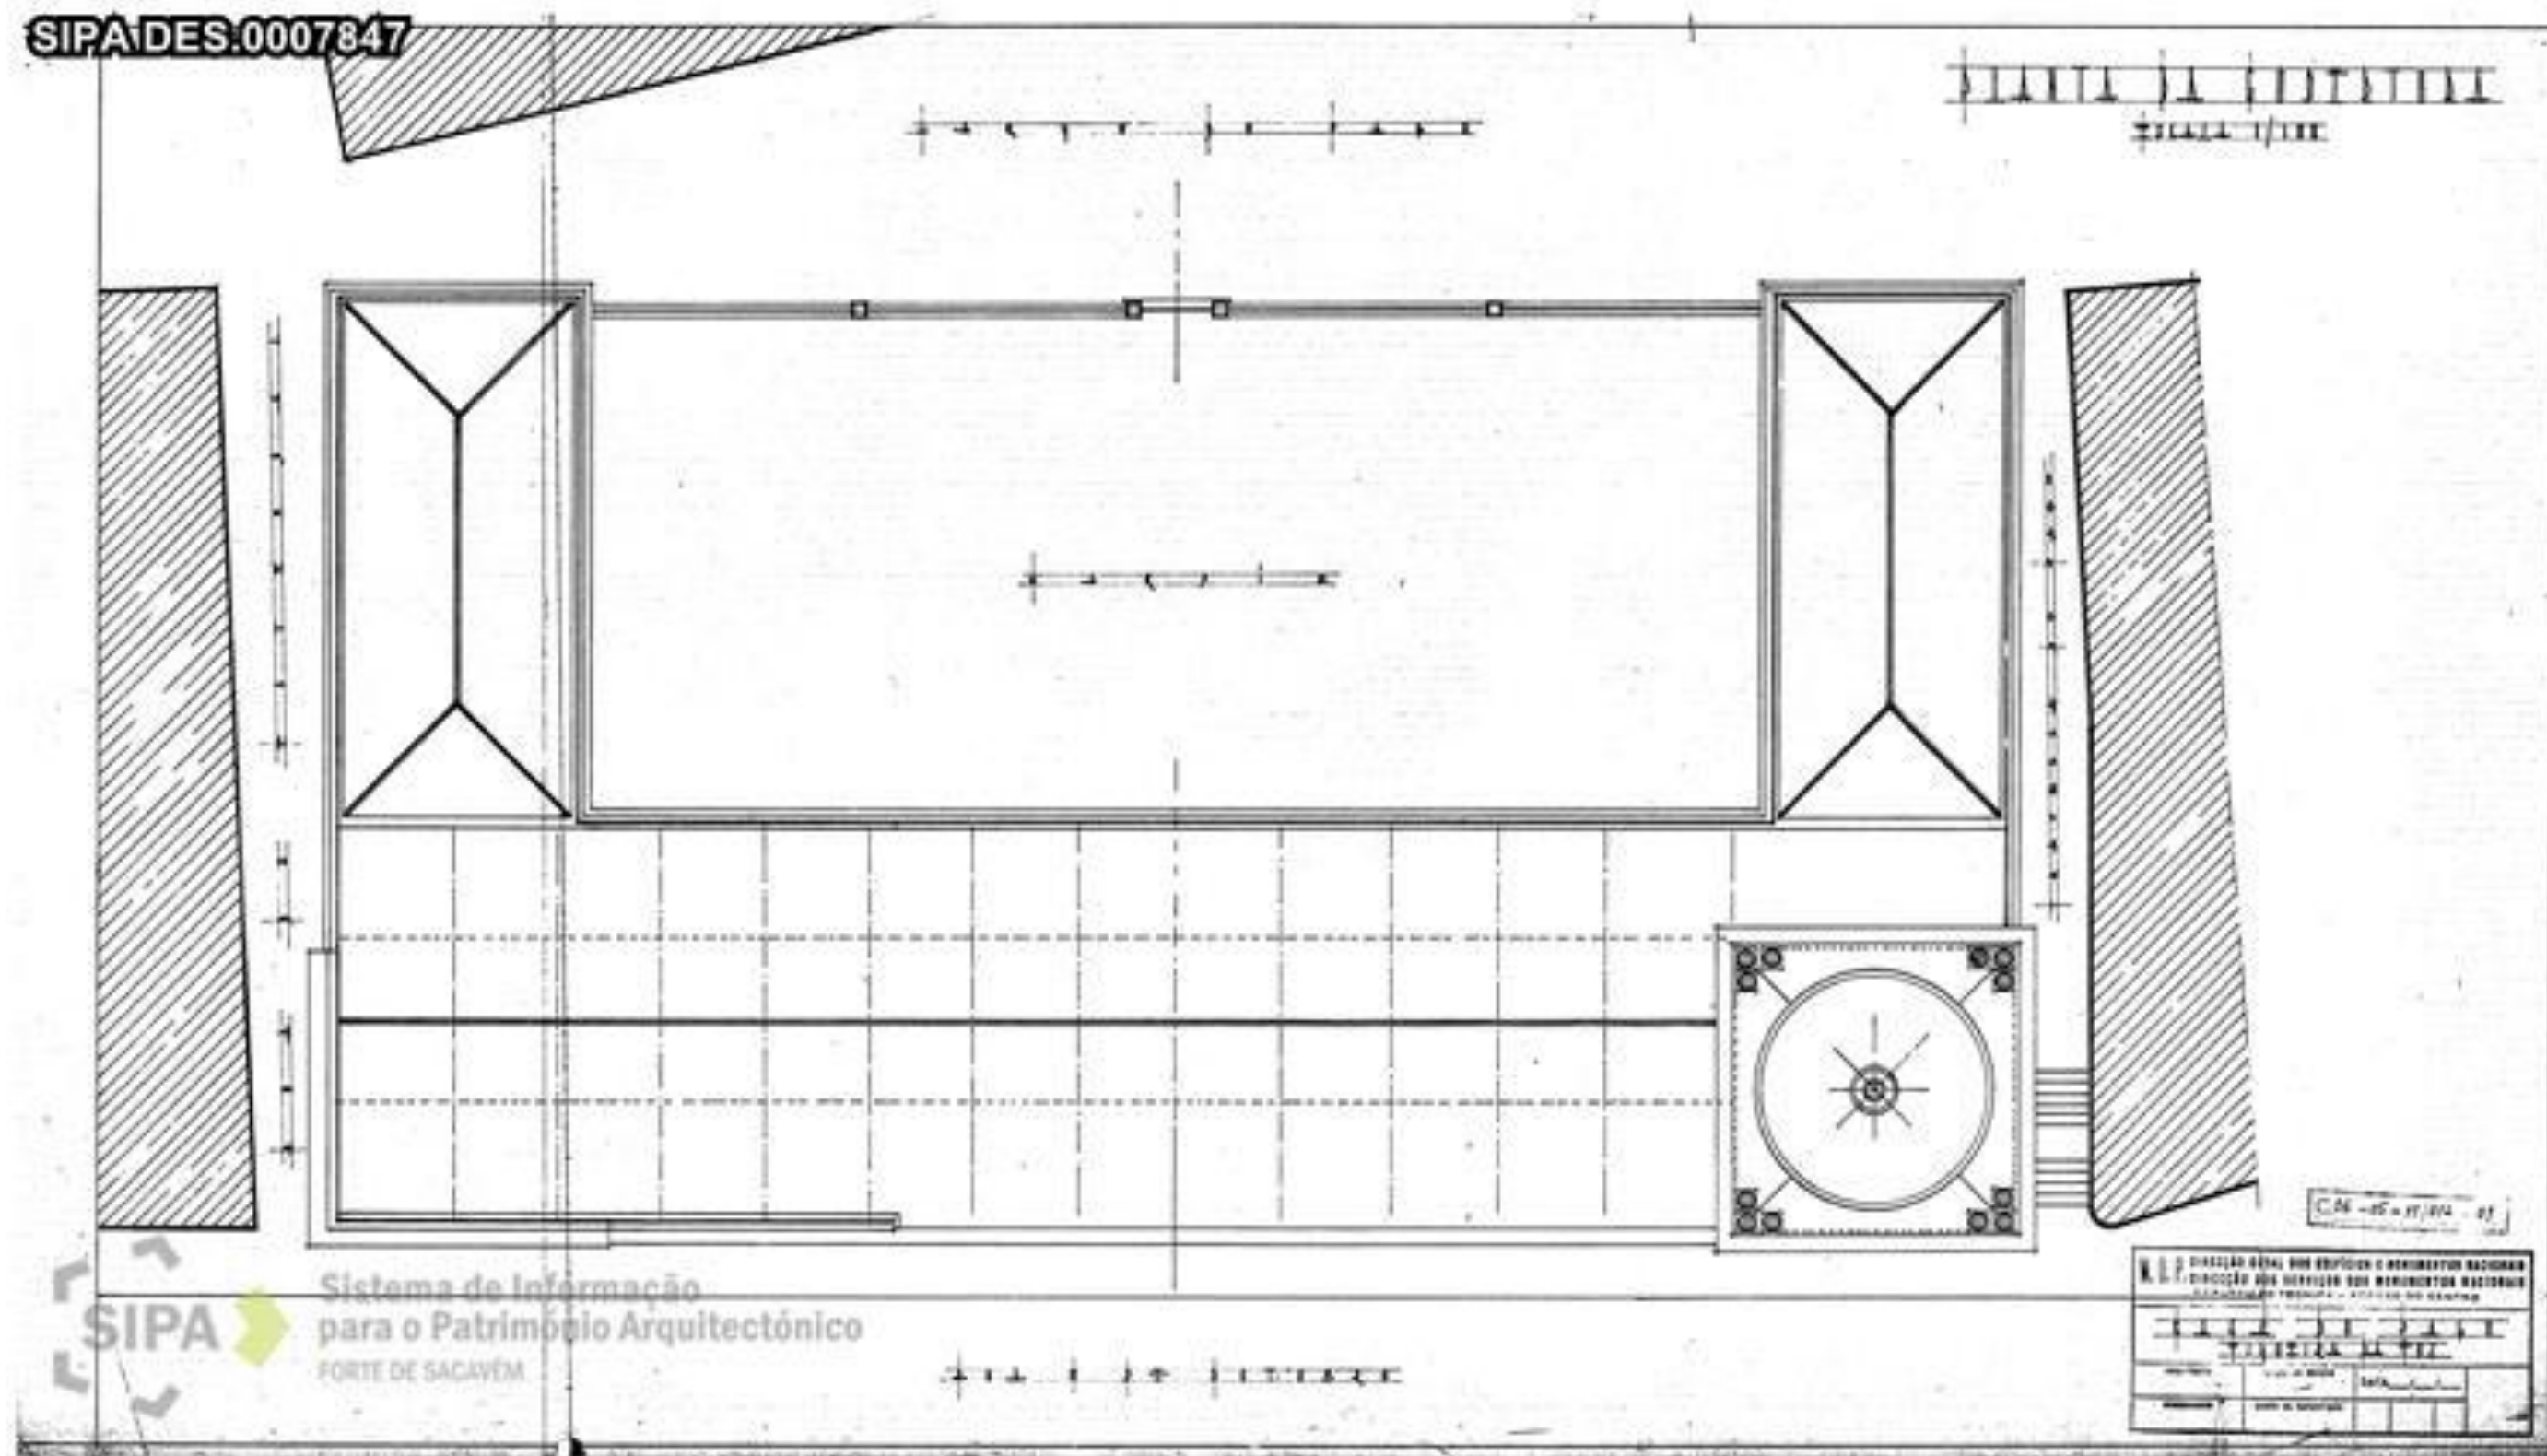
Planta da cobertura do edifício – SIPA-des-0007847
